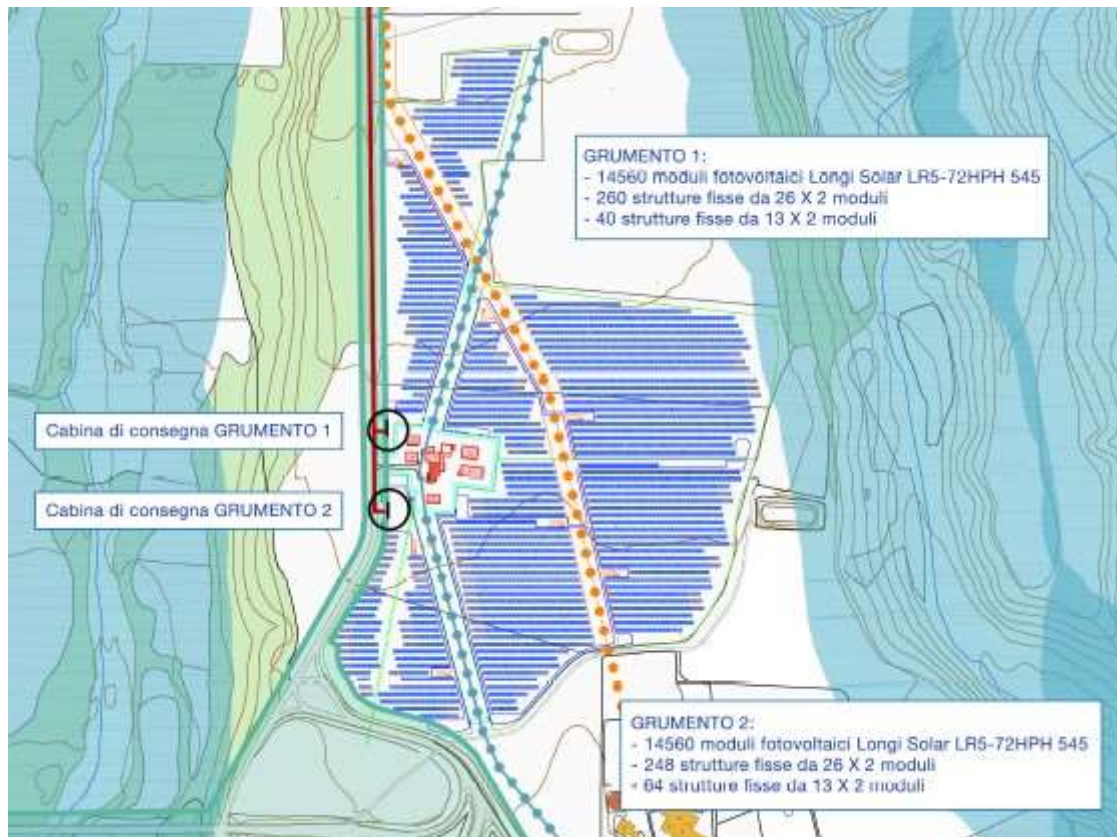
Layout dell'area di Impianto su base CTR con indicate le fasce di rispetto
